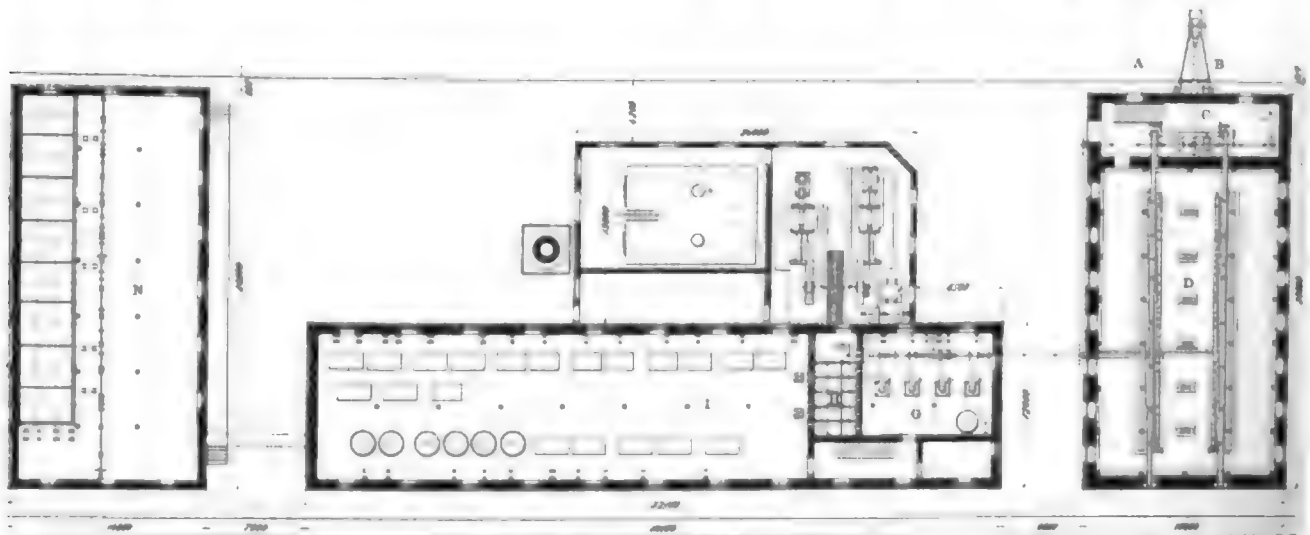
Lageplan einer modernen automatischen Mälereianlage.
